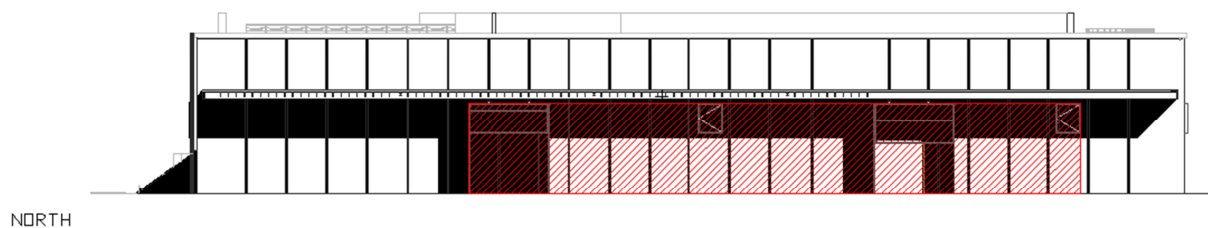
Determinazione delle piastre radianti sul piano radiante 1.
